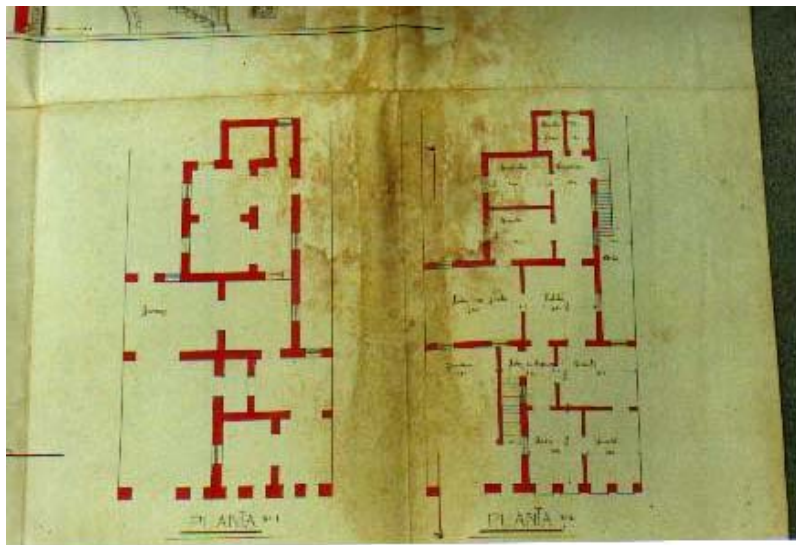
exemplo de planta baixa de um "casarão" com porão e dois pavimentos (IHGJ: arquivo)
